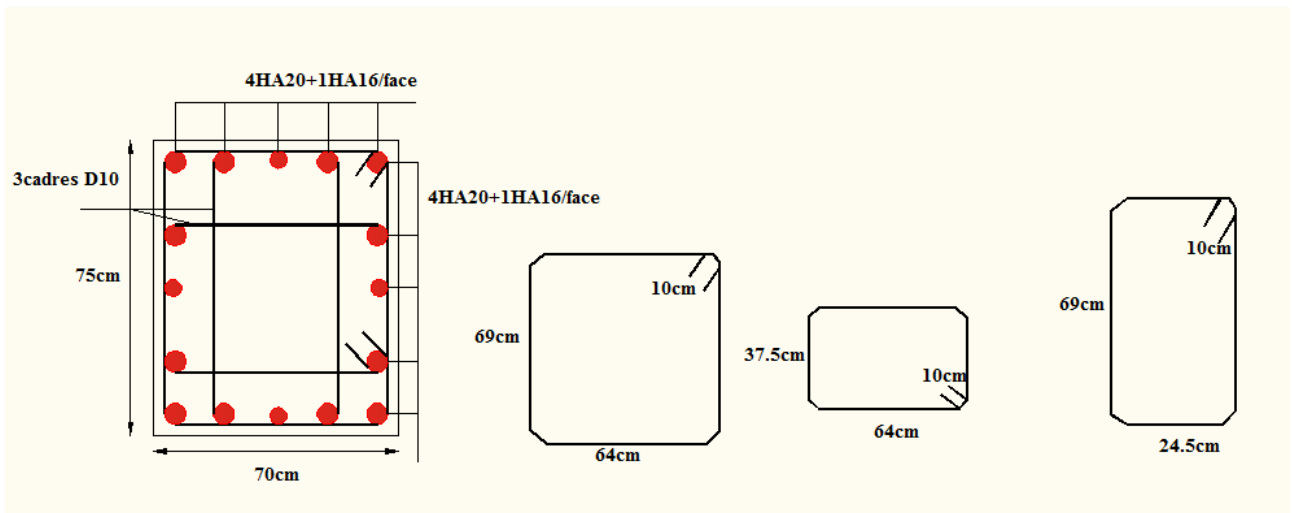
Schéma de ferrailage des poteaux d'étage 1
